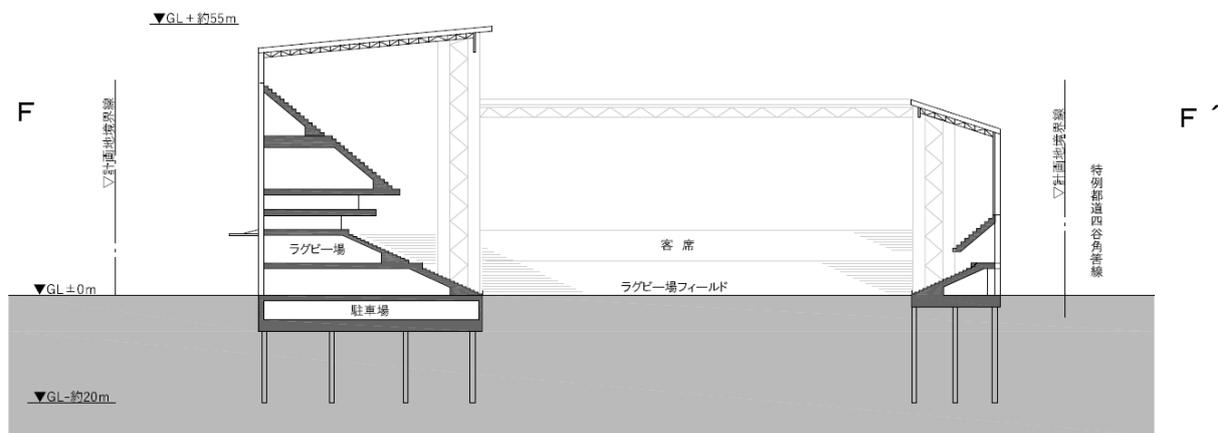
2-4 (4) 断面図 (F-F' ) S=1/1, 600
